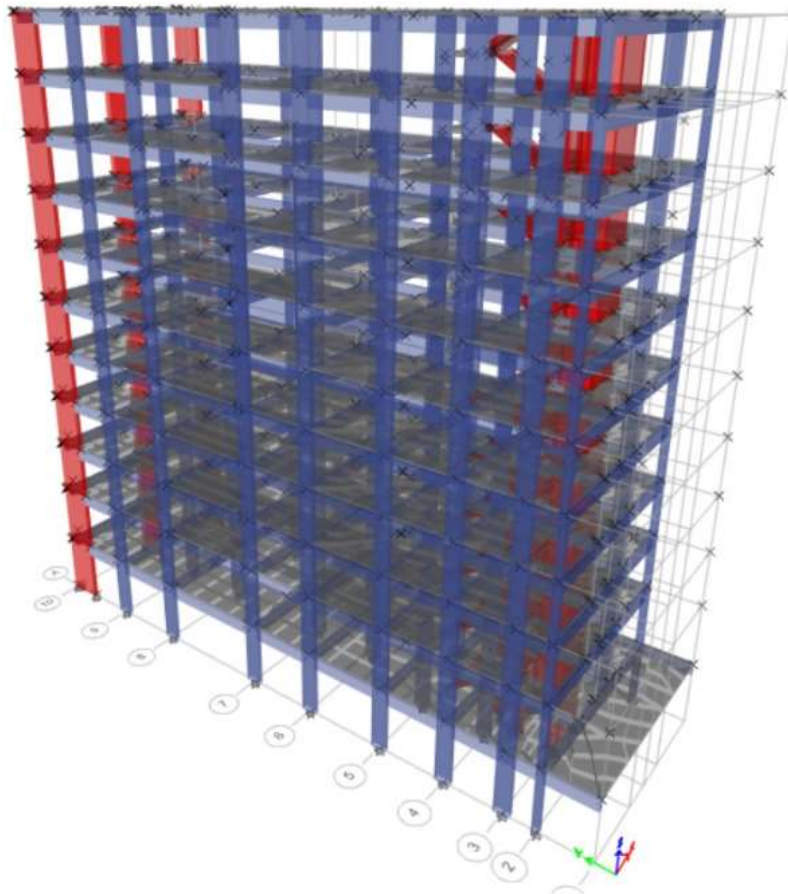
Modelo de estructuración de edificación de 10 pisos en 3D
